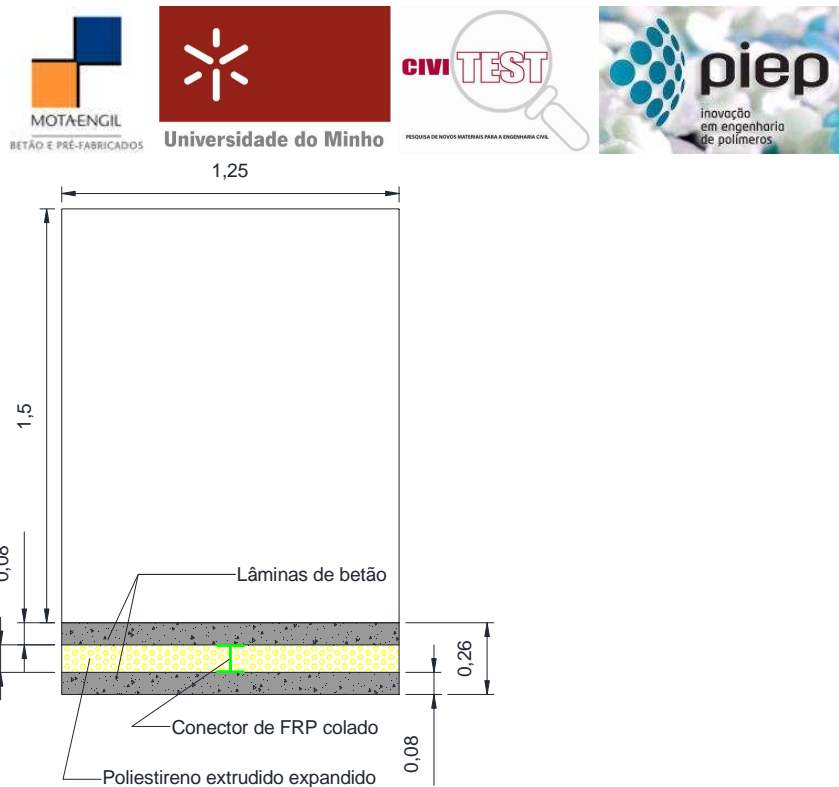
Geometria do painel sandwich com conectores perfil I colados de FRP e espessura da camada de betão de 80 mm (vista em planta, unidades em metros).
